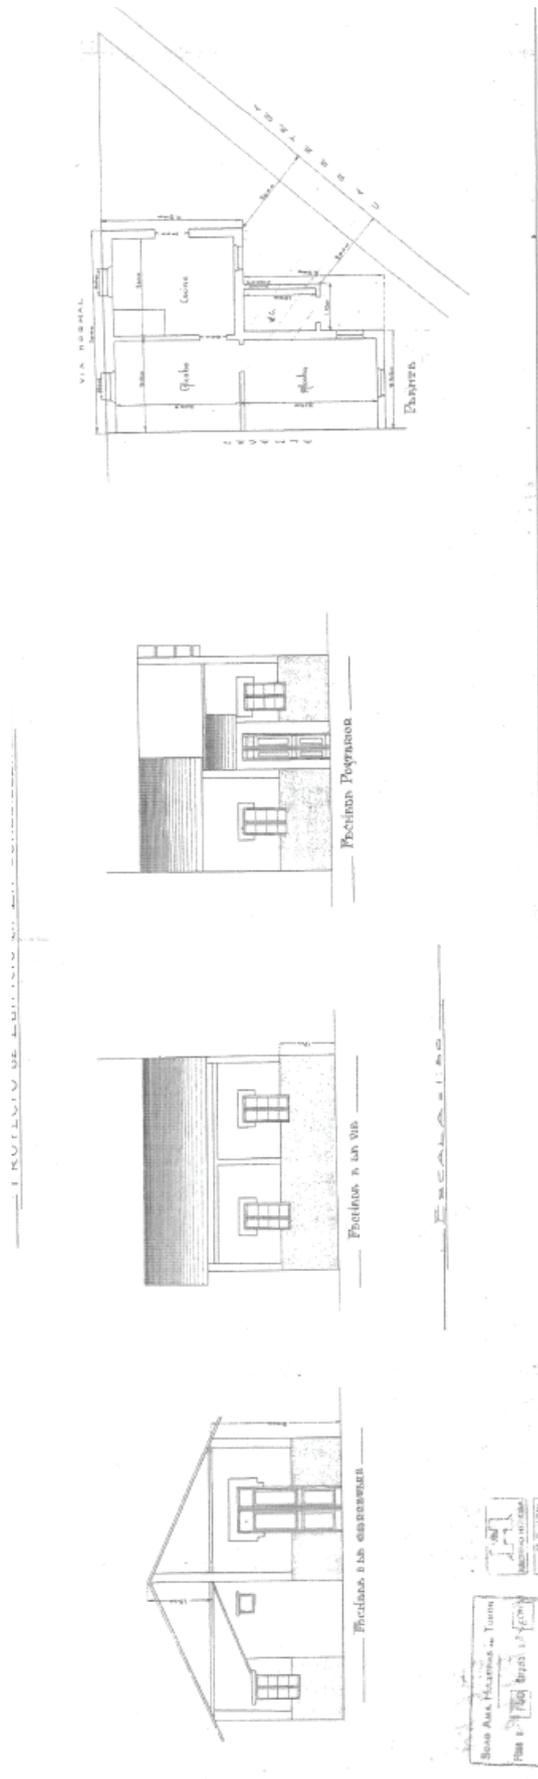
Casa unifamiliar de Huelleras del Turón. Planta y alzado. AHH SHT A0.4/4744
